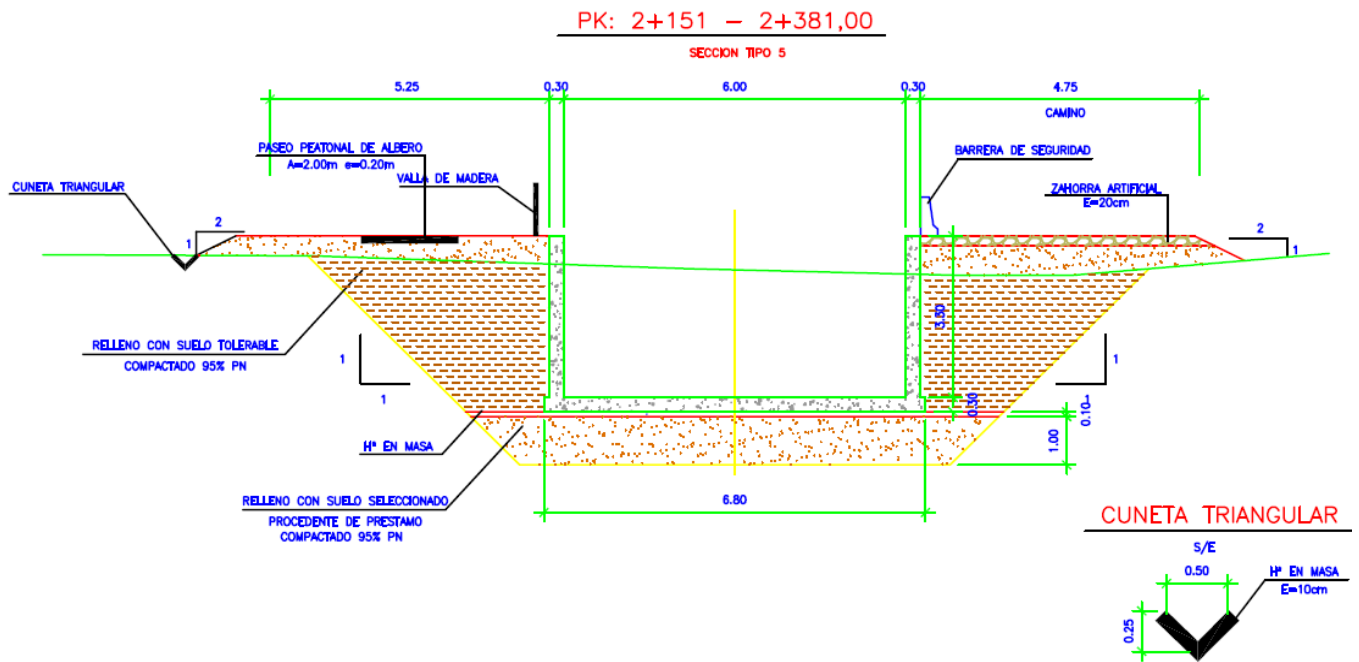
Caracterización geométrica sección tipo 5 (Proyecto de refuerzo estructural del canal de desvío del arroyo Calzas Anchas. t.m. de Utrera (SEVILLA)).
